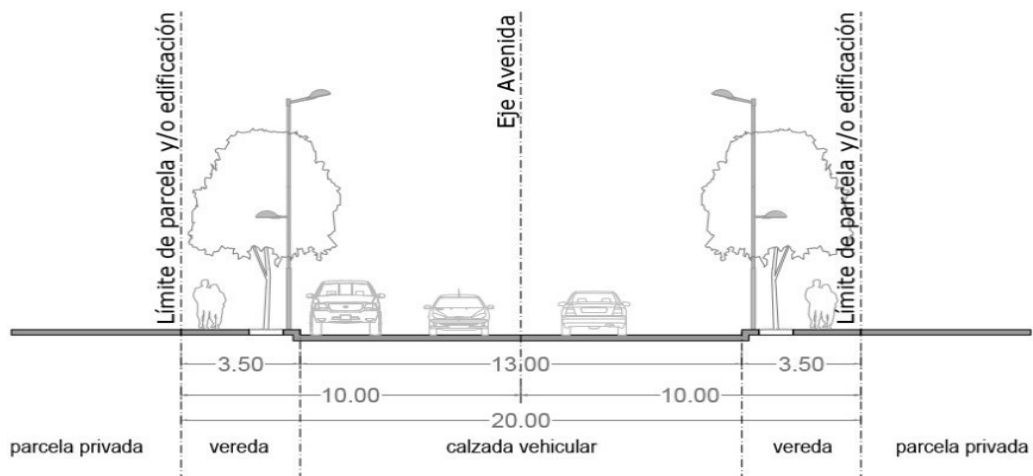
Sección transversal de Vías Avenidas Tipo 6.
